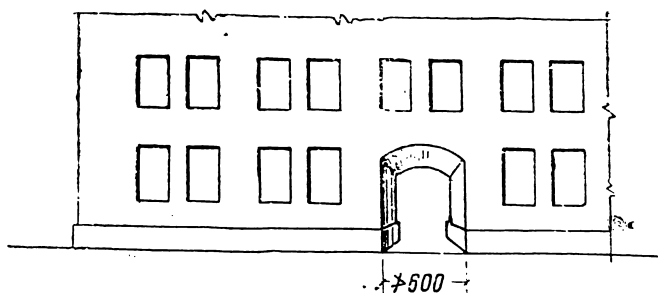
Перекрытие из цилиндрических или крестовых сводов над проездом
